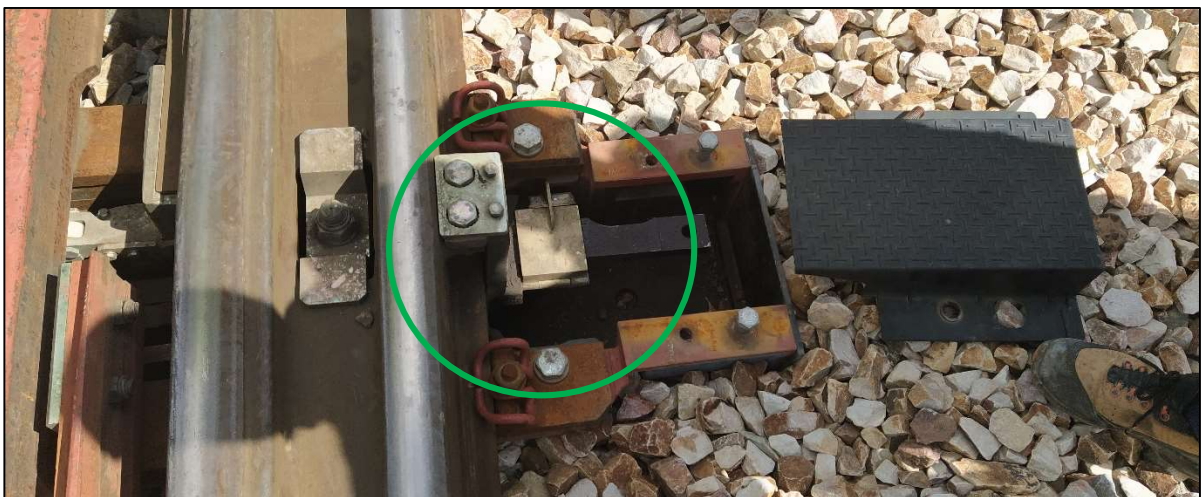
Vista de la brida tipo sándwich instalada en el desvío D4.
